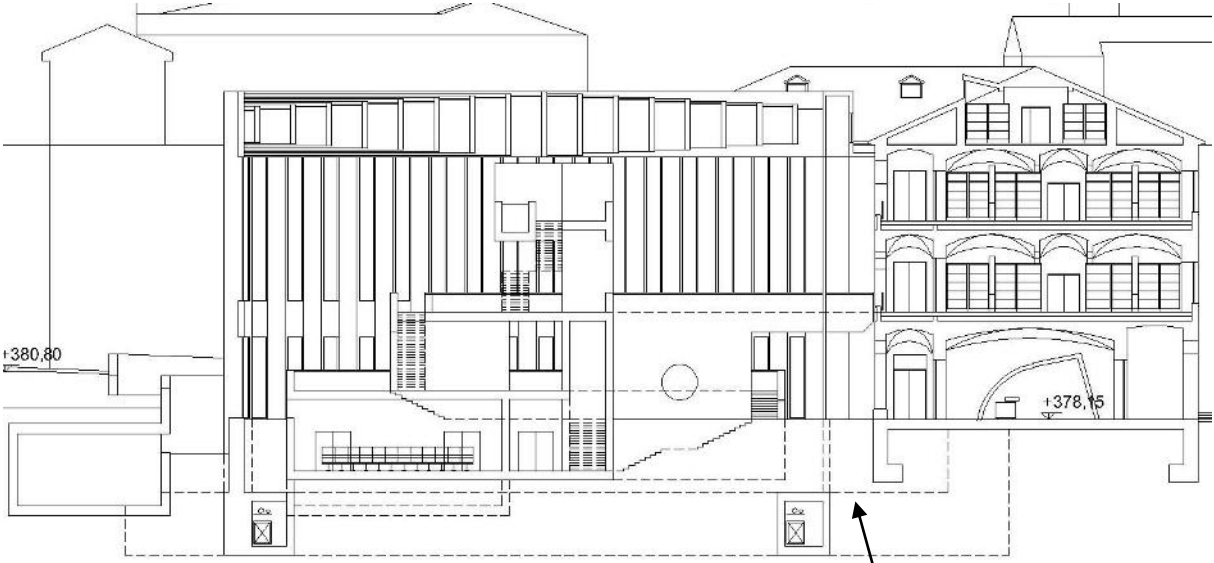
Sezione con indicazione del cunicolo impianti a servizio della biblioteca
